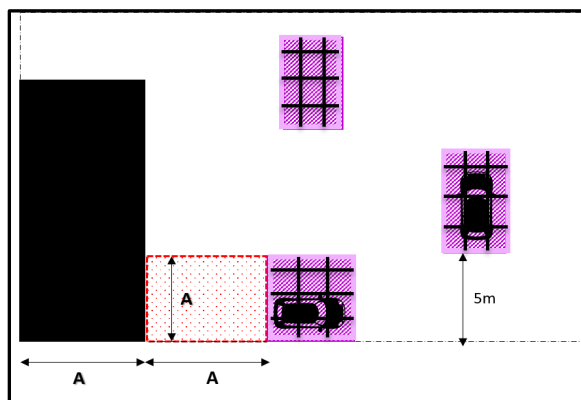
zones d'implantation possibles pour les extensions de la construction existante.
